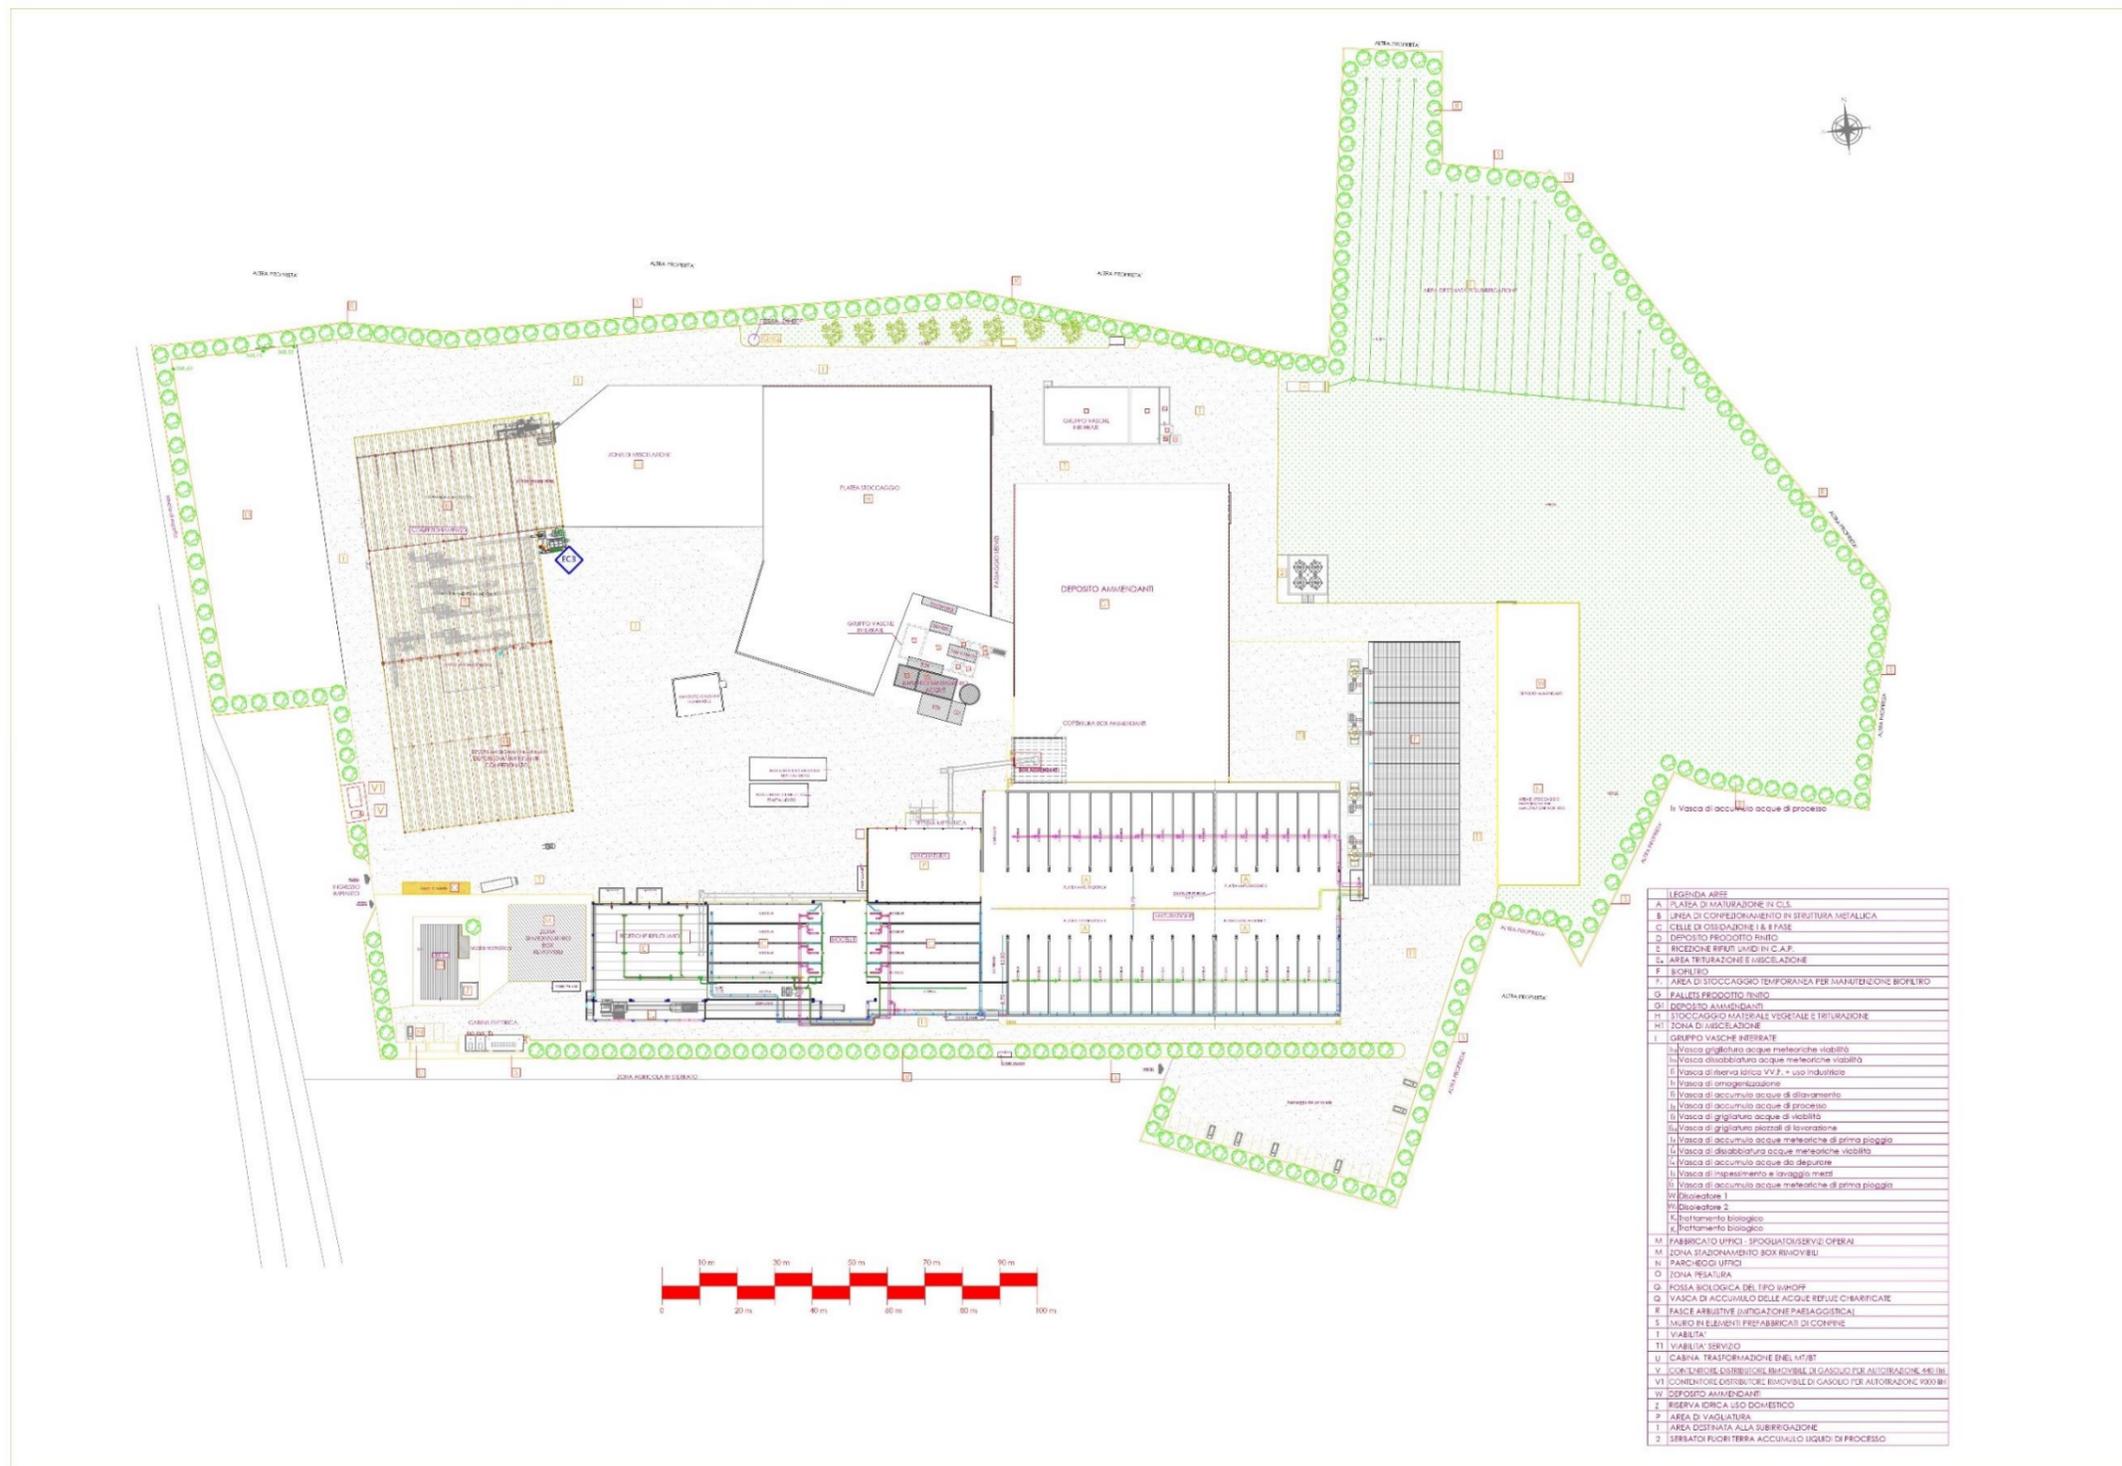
Planimetria generale Primo stralcio funzionale al 31.12.2023
